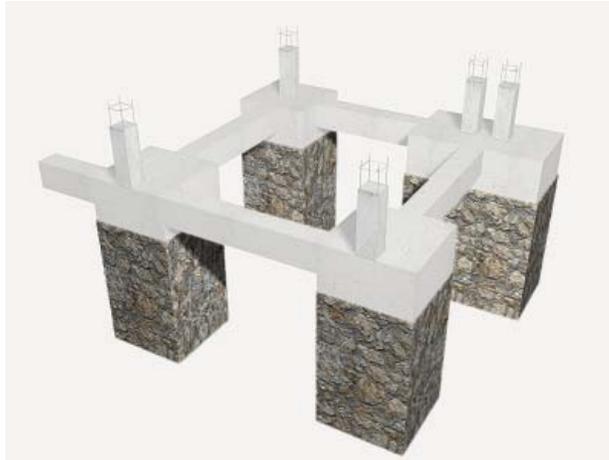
Aplicación de concreto pre-colocado en cimentaciones
